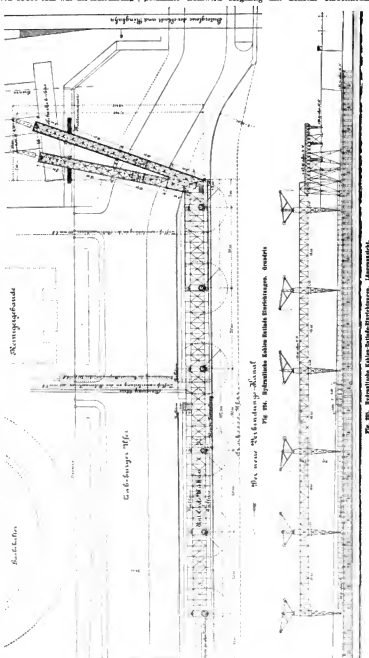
Hydraulische Kähne Rähle Einrichtungen. Querschnitt.
